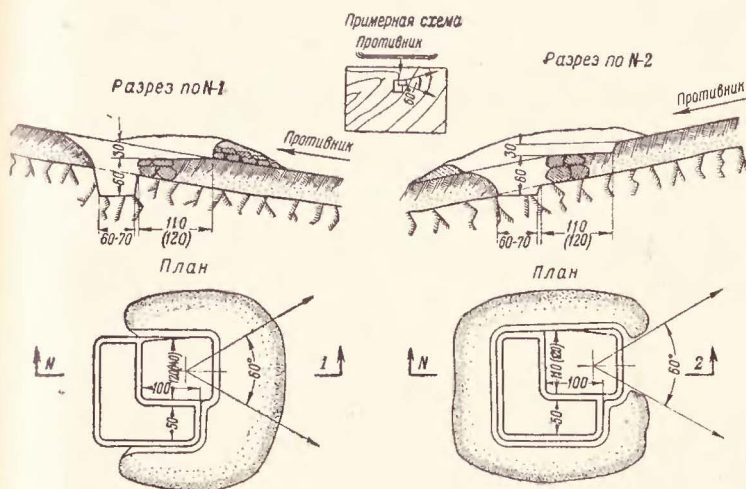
Одиночный окоп для стрельбы с колена из ручного (станкового) пулемета
